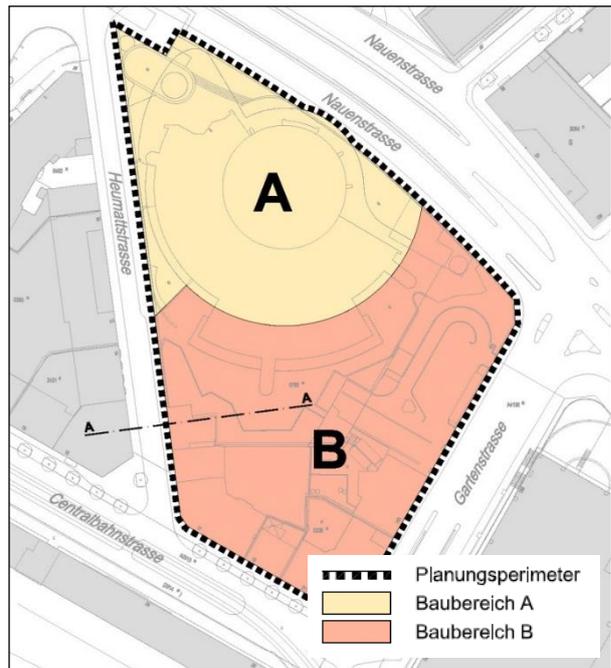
Bebauungsplan Nr. 214 (genordet); Quelle: S&A,
